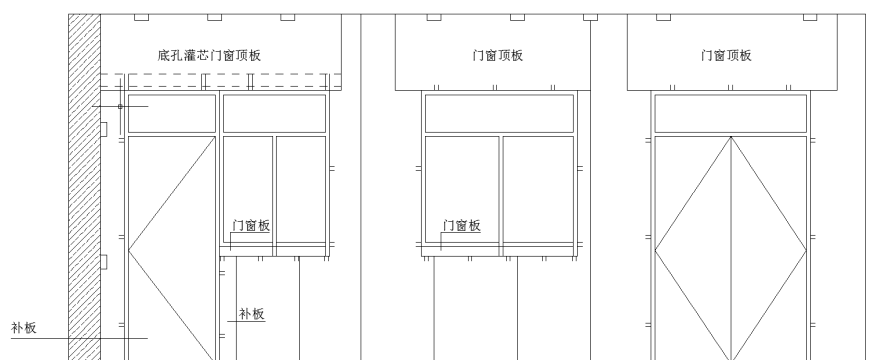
墙板与门窗洞口连接平面示意图
